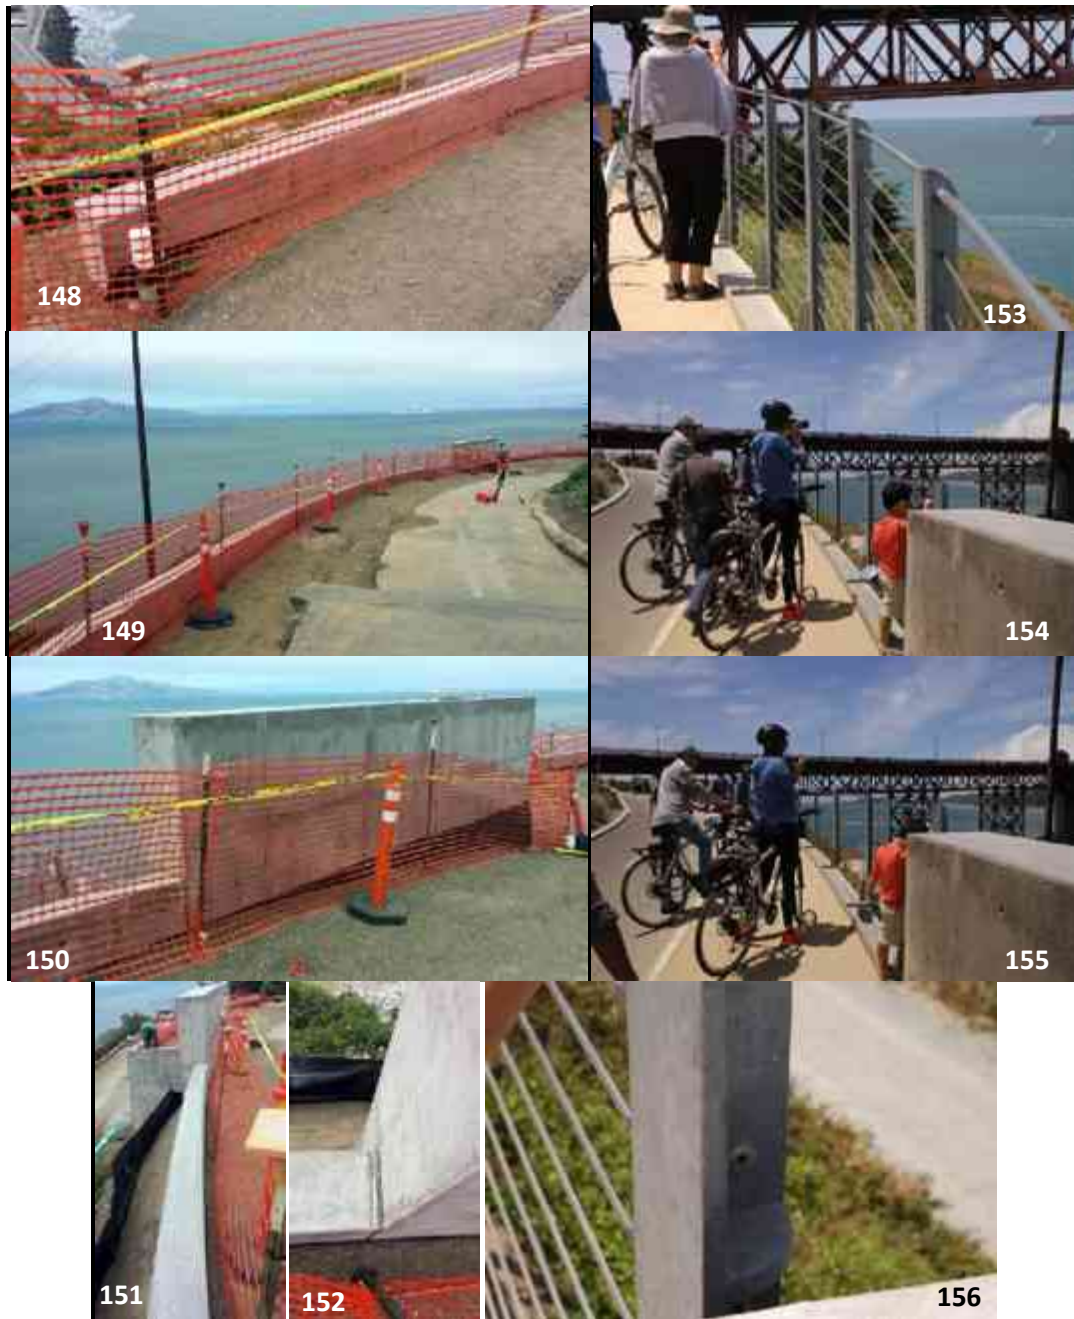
Paradero turístico "Golden Gate Bridge Overlook" / Sitio de colocación del Stainless Steel Cable Guardrail, antes del trabajo realizado.
